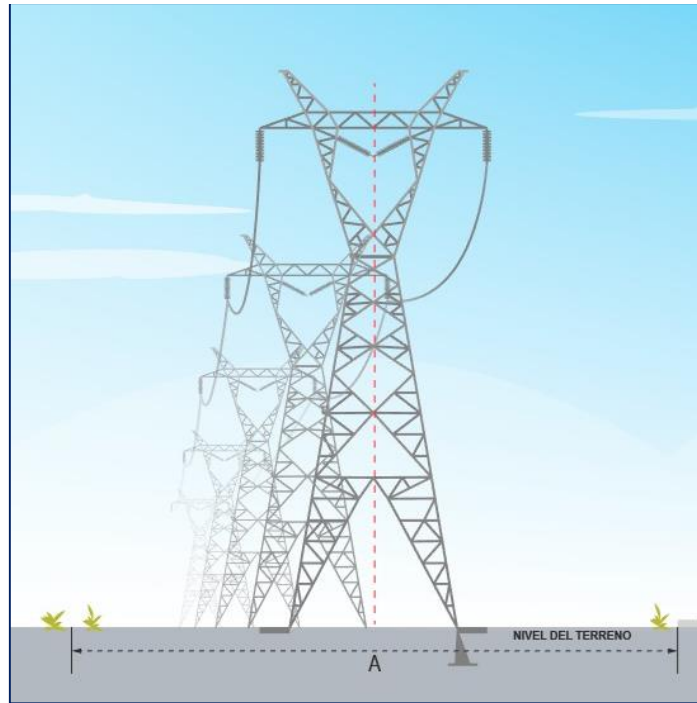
Esquema de las estructuras de línea, Resolución AETN 409/2019
